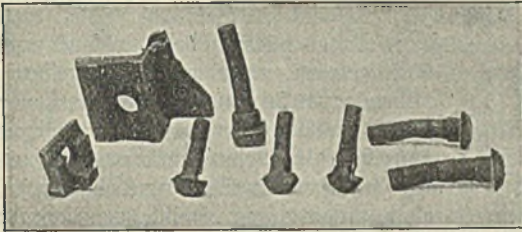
Infolge der Wanderung zerstörtes Kleiseisenzeug, durchgedrückte Laschenbolzen, eingefressene Klemmplatten und Hakenschrauben.
